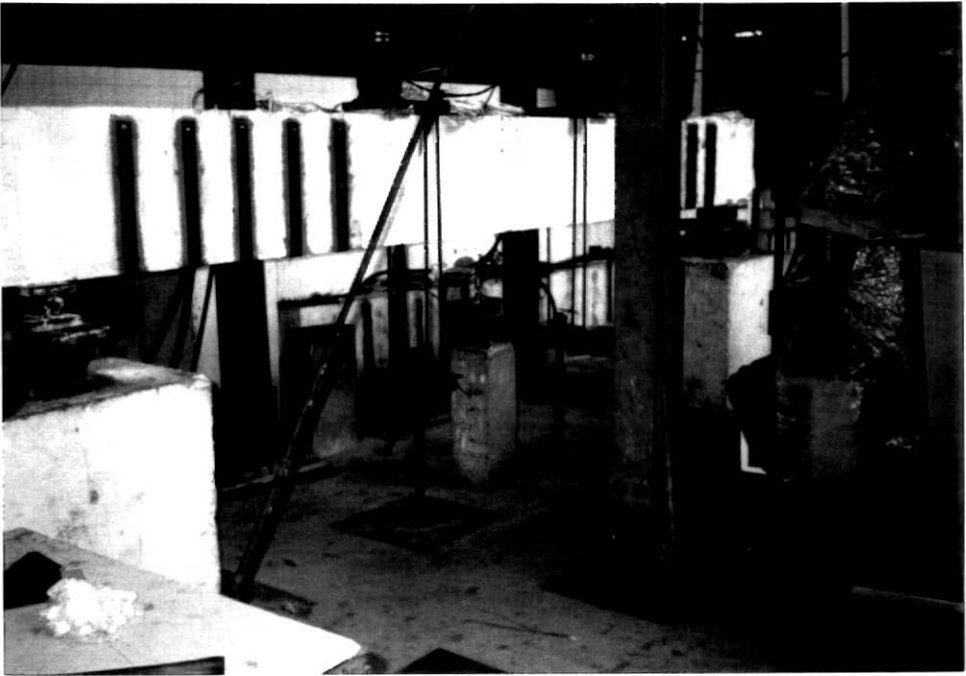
Viga V2 após o reforço executado com a viga submetida a duas cargas concentradas de 50 KN
